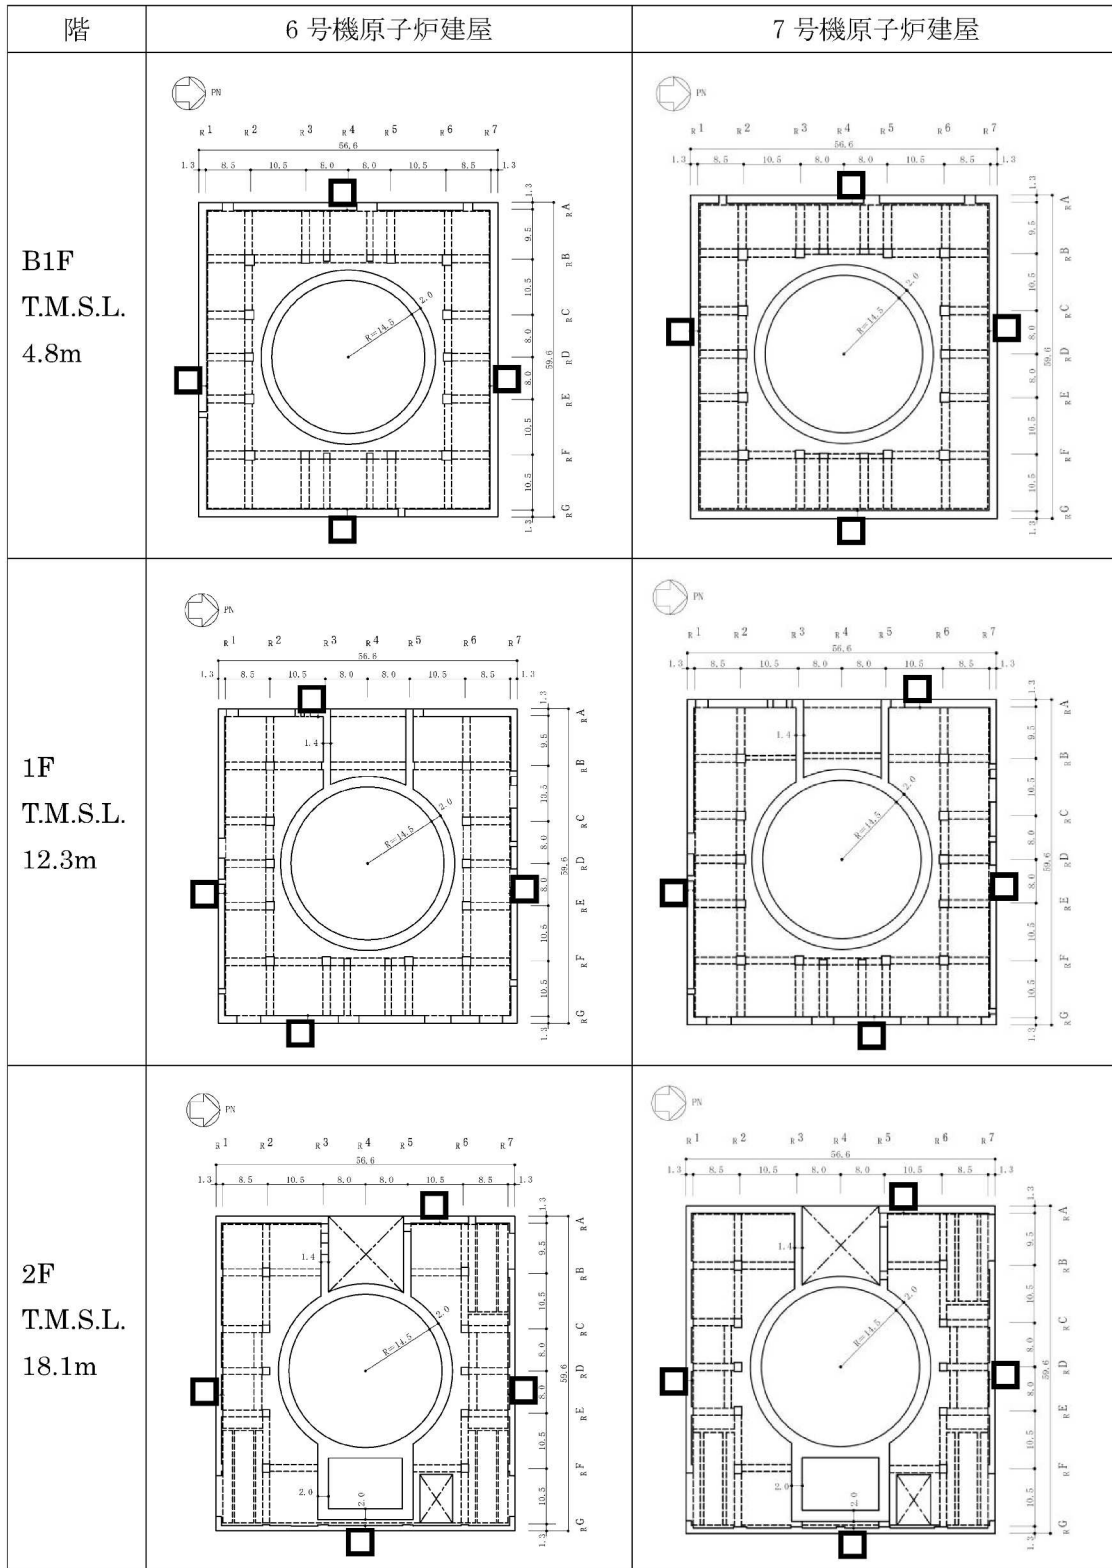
6号機原子炉建屋及び7号機原子炉建屋の概略平面図(3/4)(単位:m)
